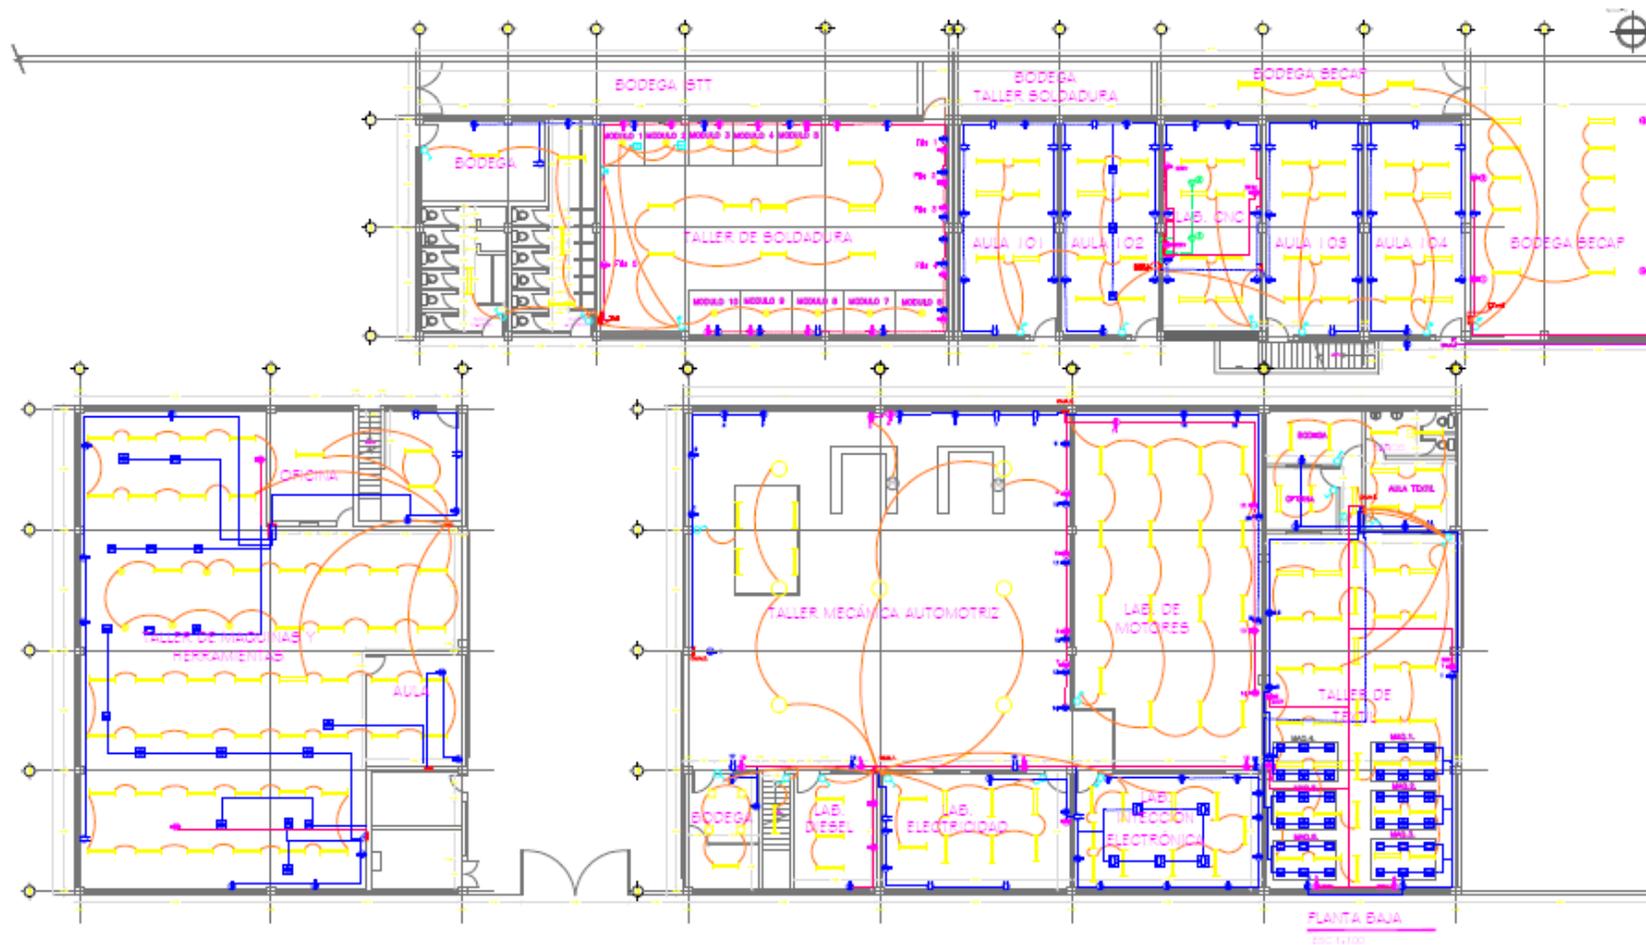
Plano eléctrico bloques DELTA – BETA - GAMMA
